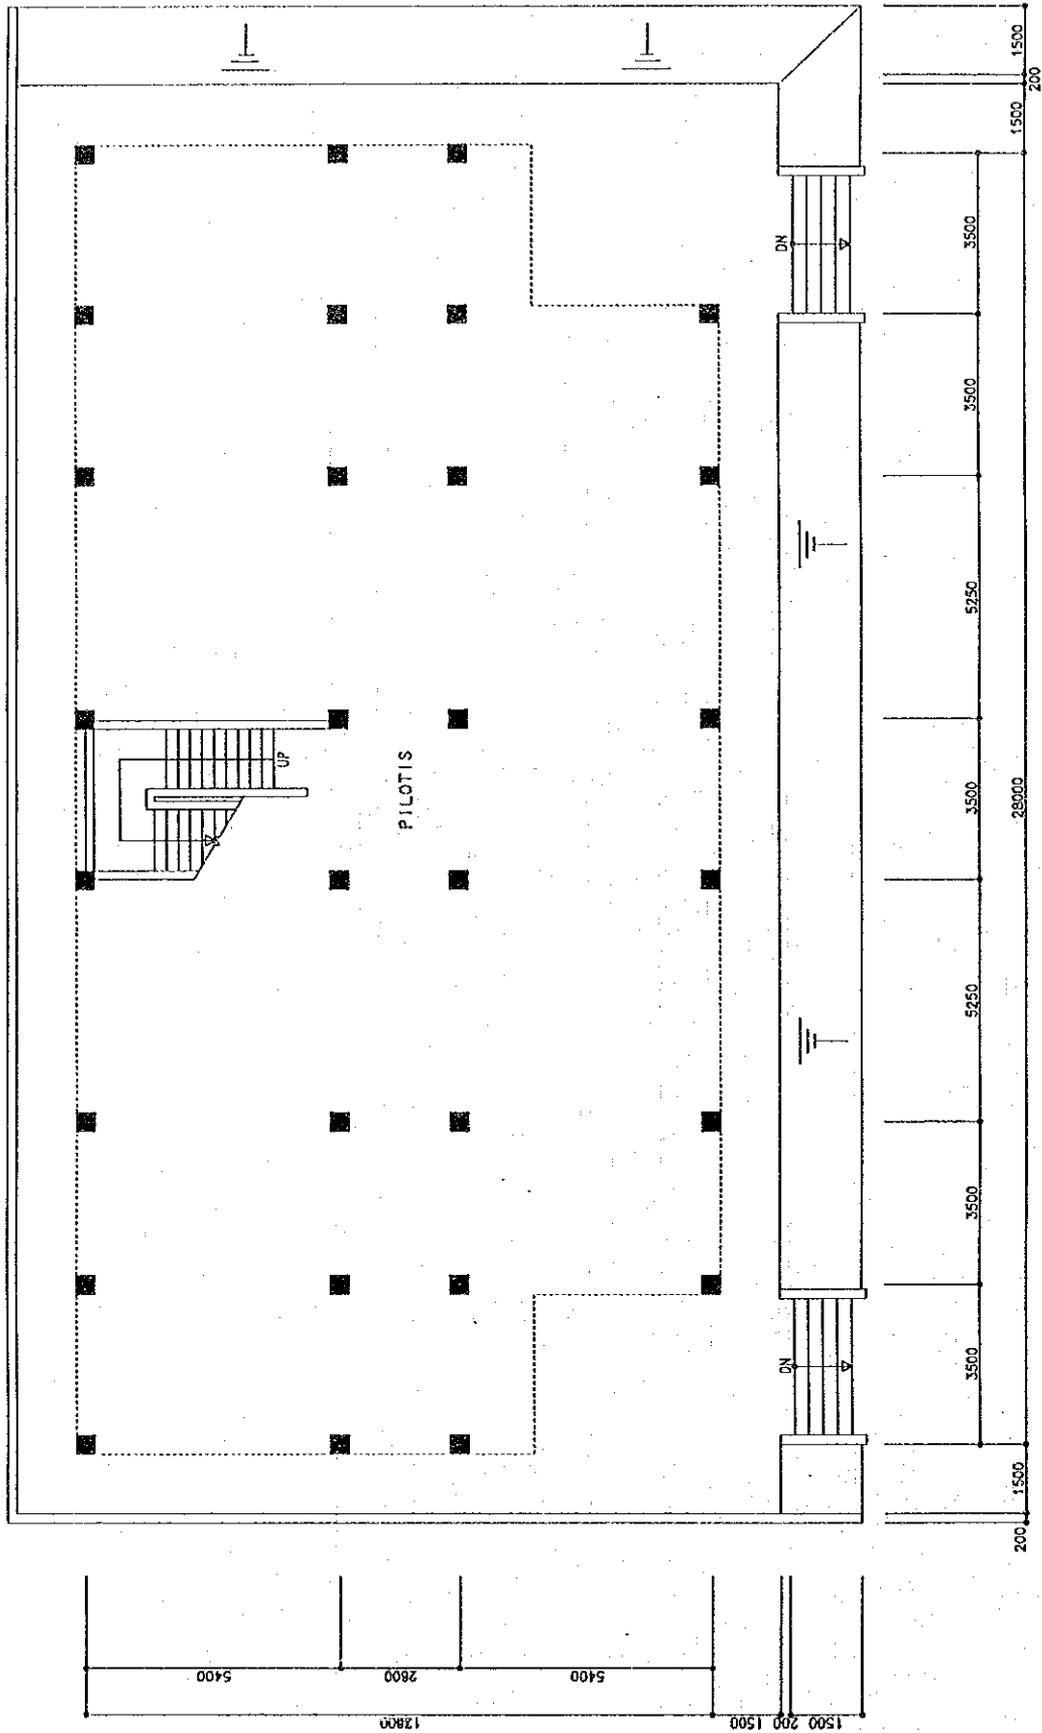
(1) 1 階平面図 (5 教室タイプ)
